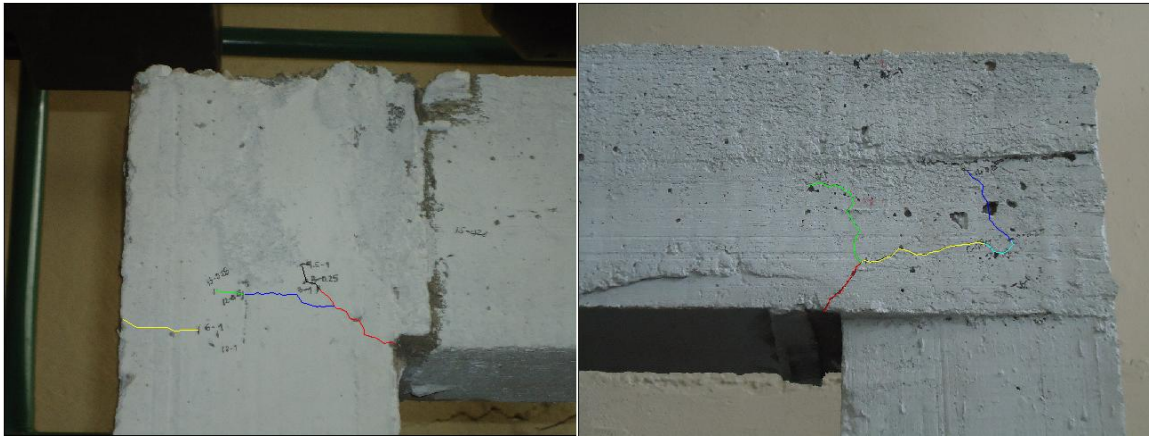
Determinación de la longitud de fisuras para el pórtico 1
